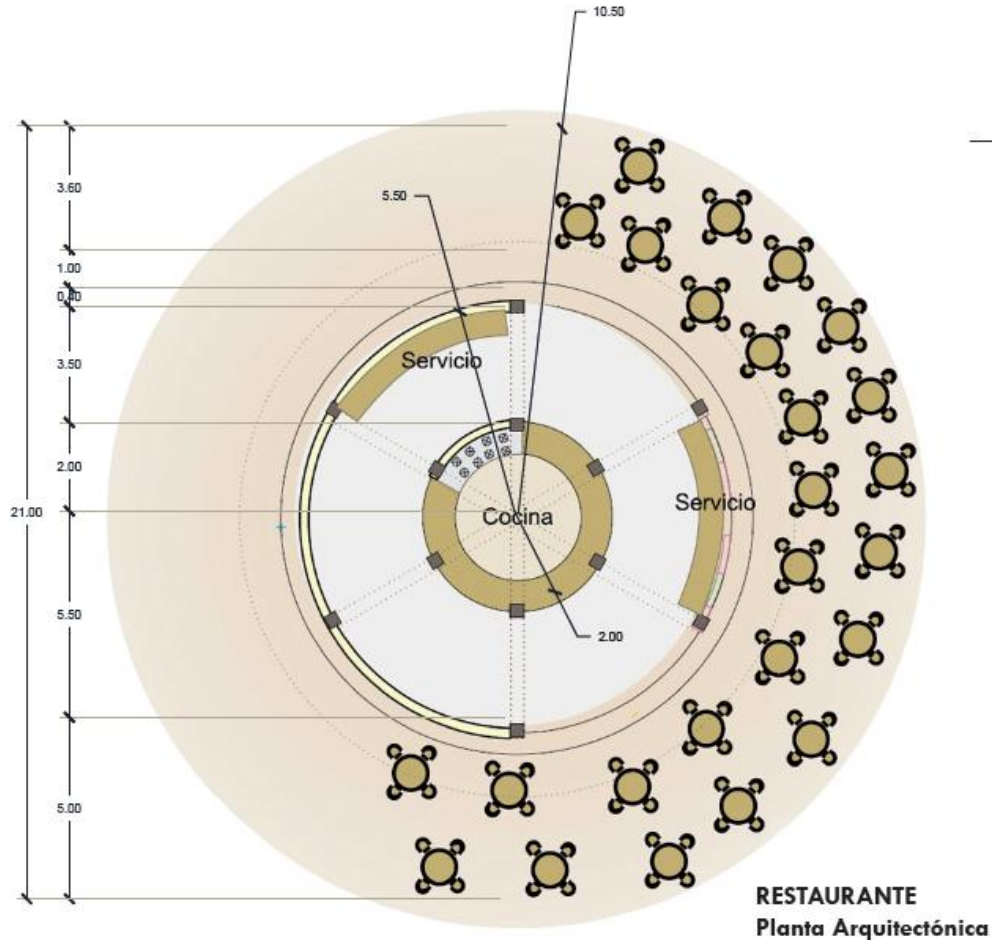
Ejemplo de una planta arquitectónica de una cocina y restaurante para un centro ecoturístico.
